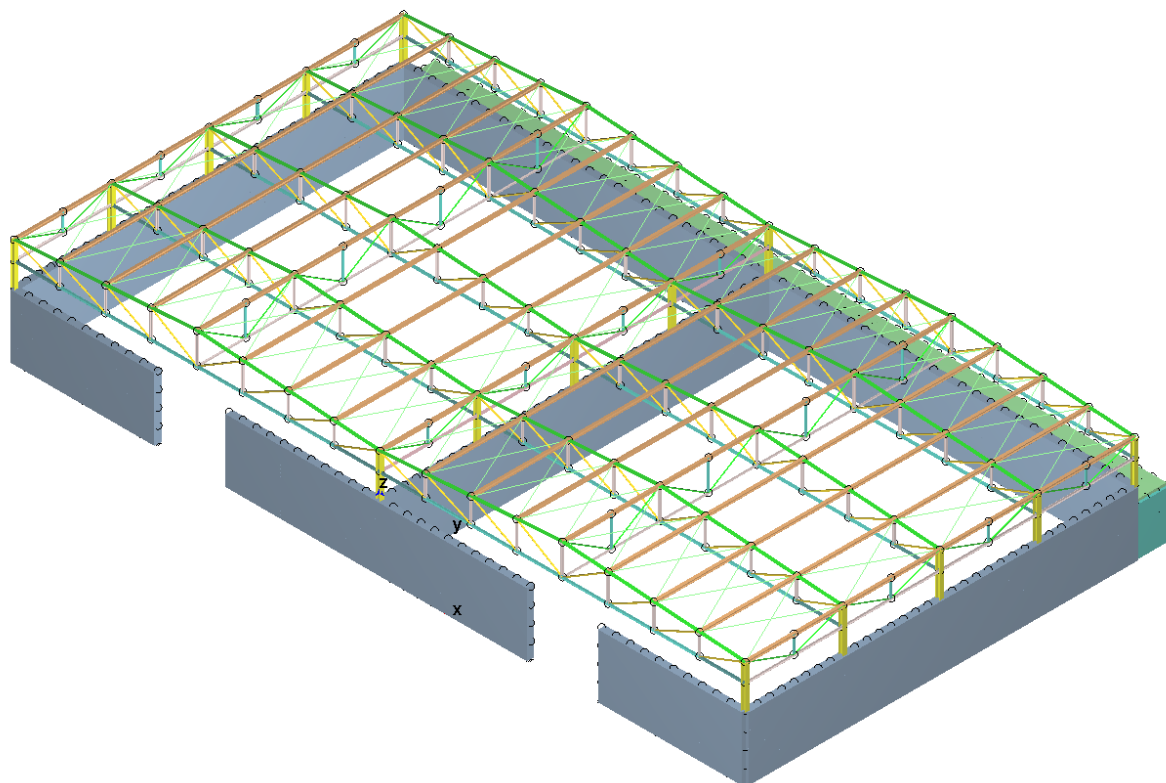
Vista estrusa del modello 3D dell'elevazione
